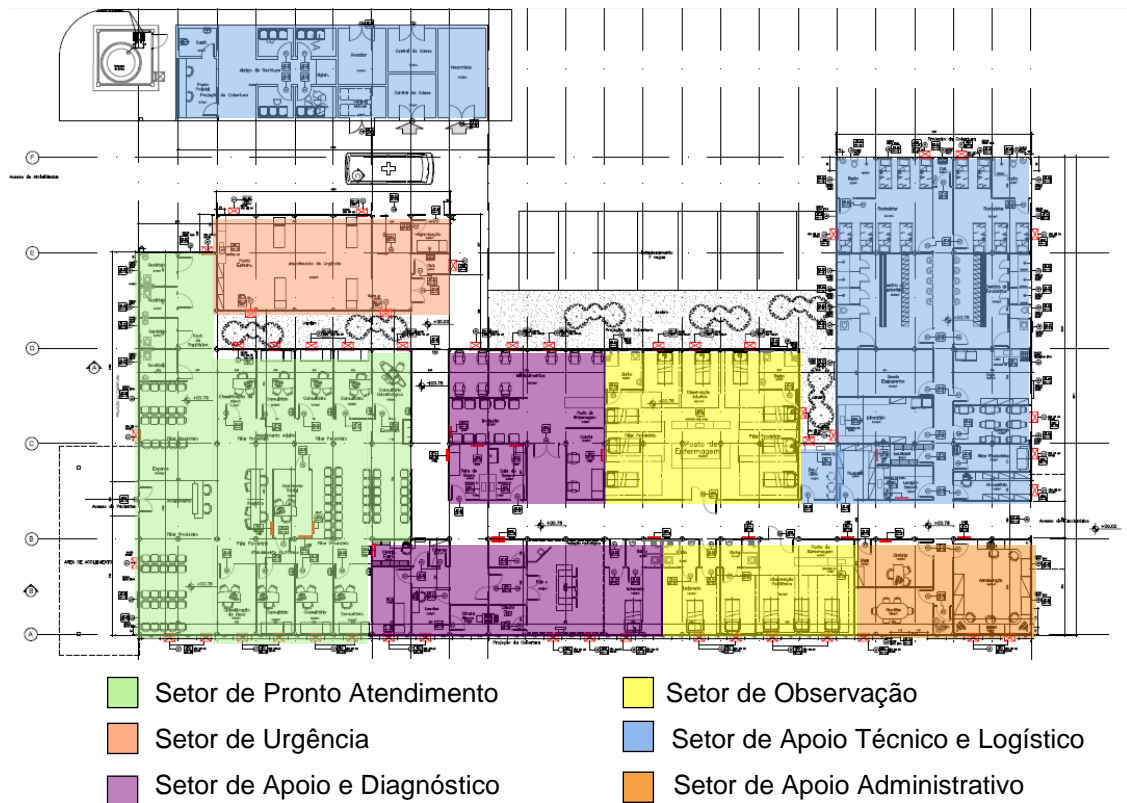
Planta Baixa com Setorização da UPA Samambaia/DF.
